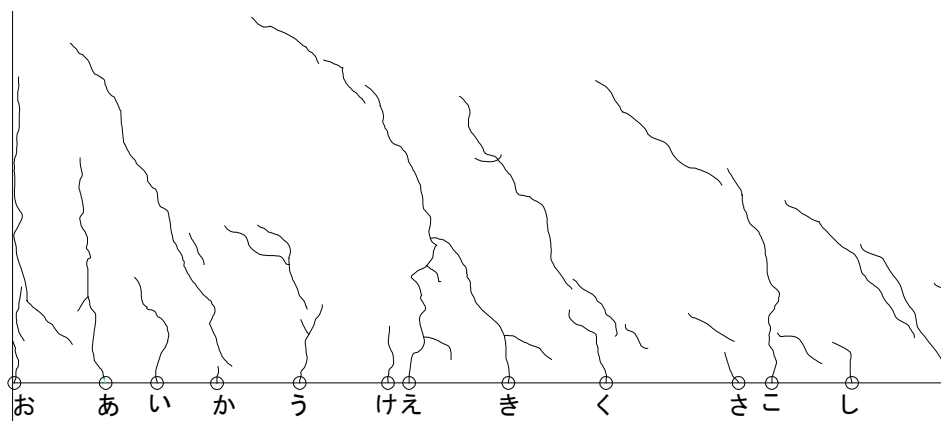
基礎梁ひび割れ幅測定位置(試験体 A-4 正載荷)
